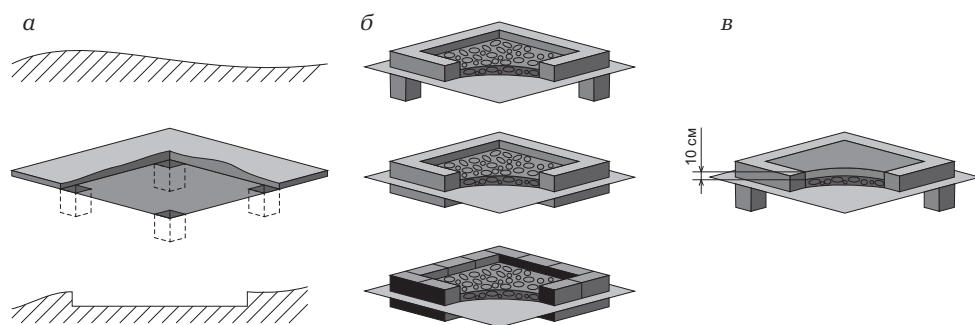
Основания для беседки: а — земляное; б — насыпное; в — заливное
